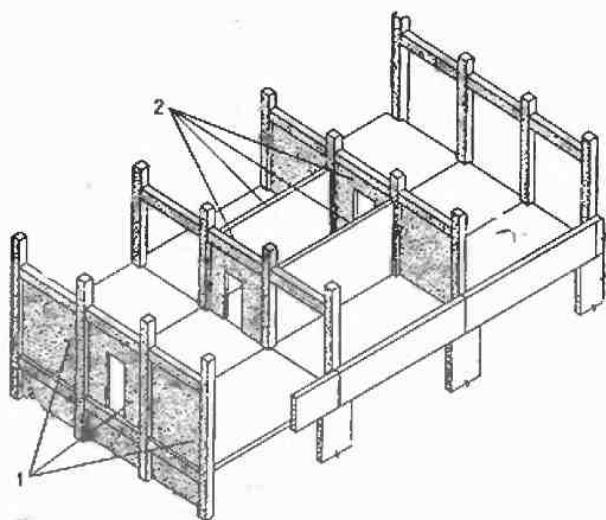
Расположение стенок жесткости в каркасно-панельном здании
